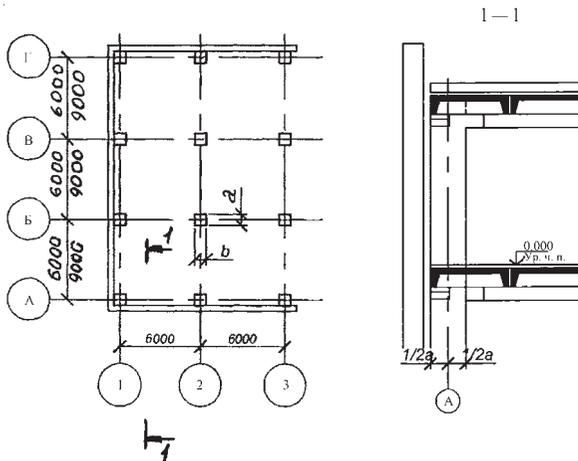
Привязка колонн многоэтажных зданий к координационным осям (здания со связевыми схемами каркасов)
